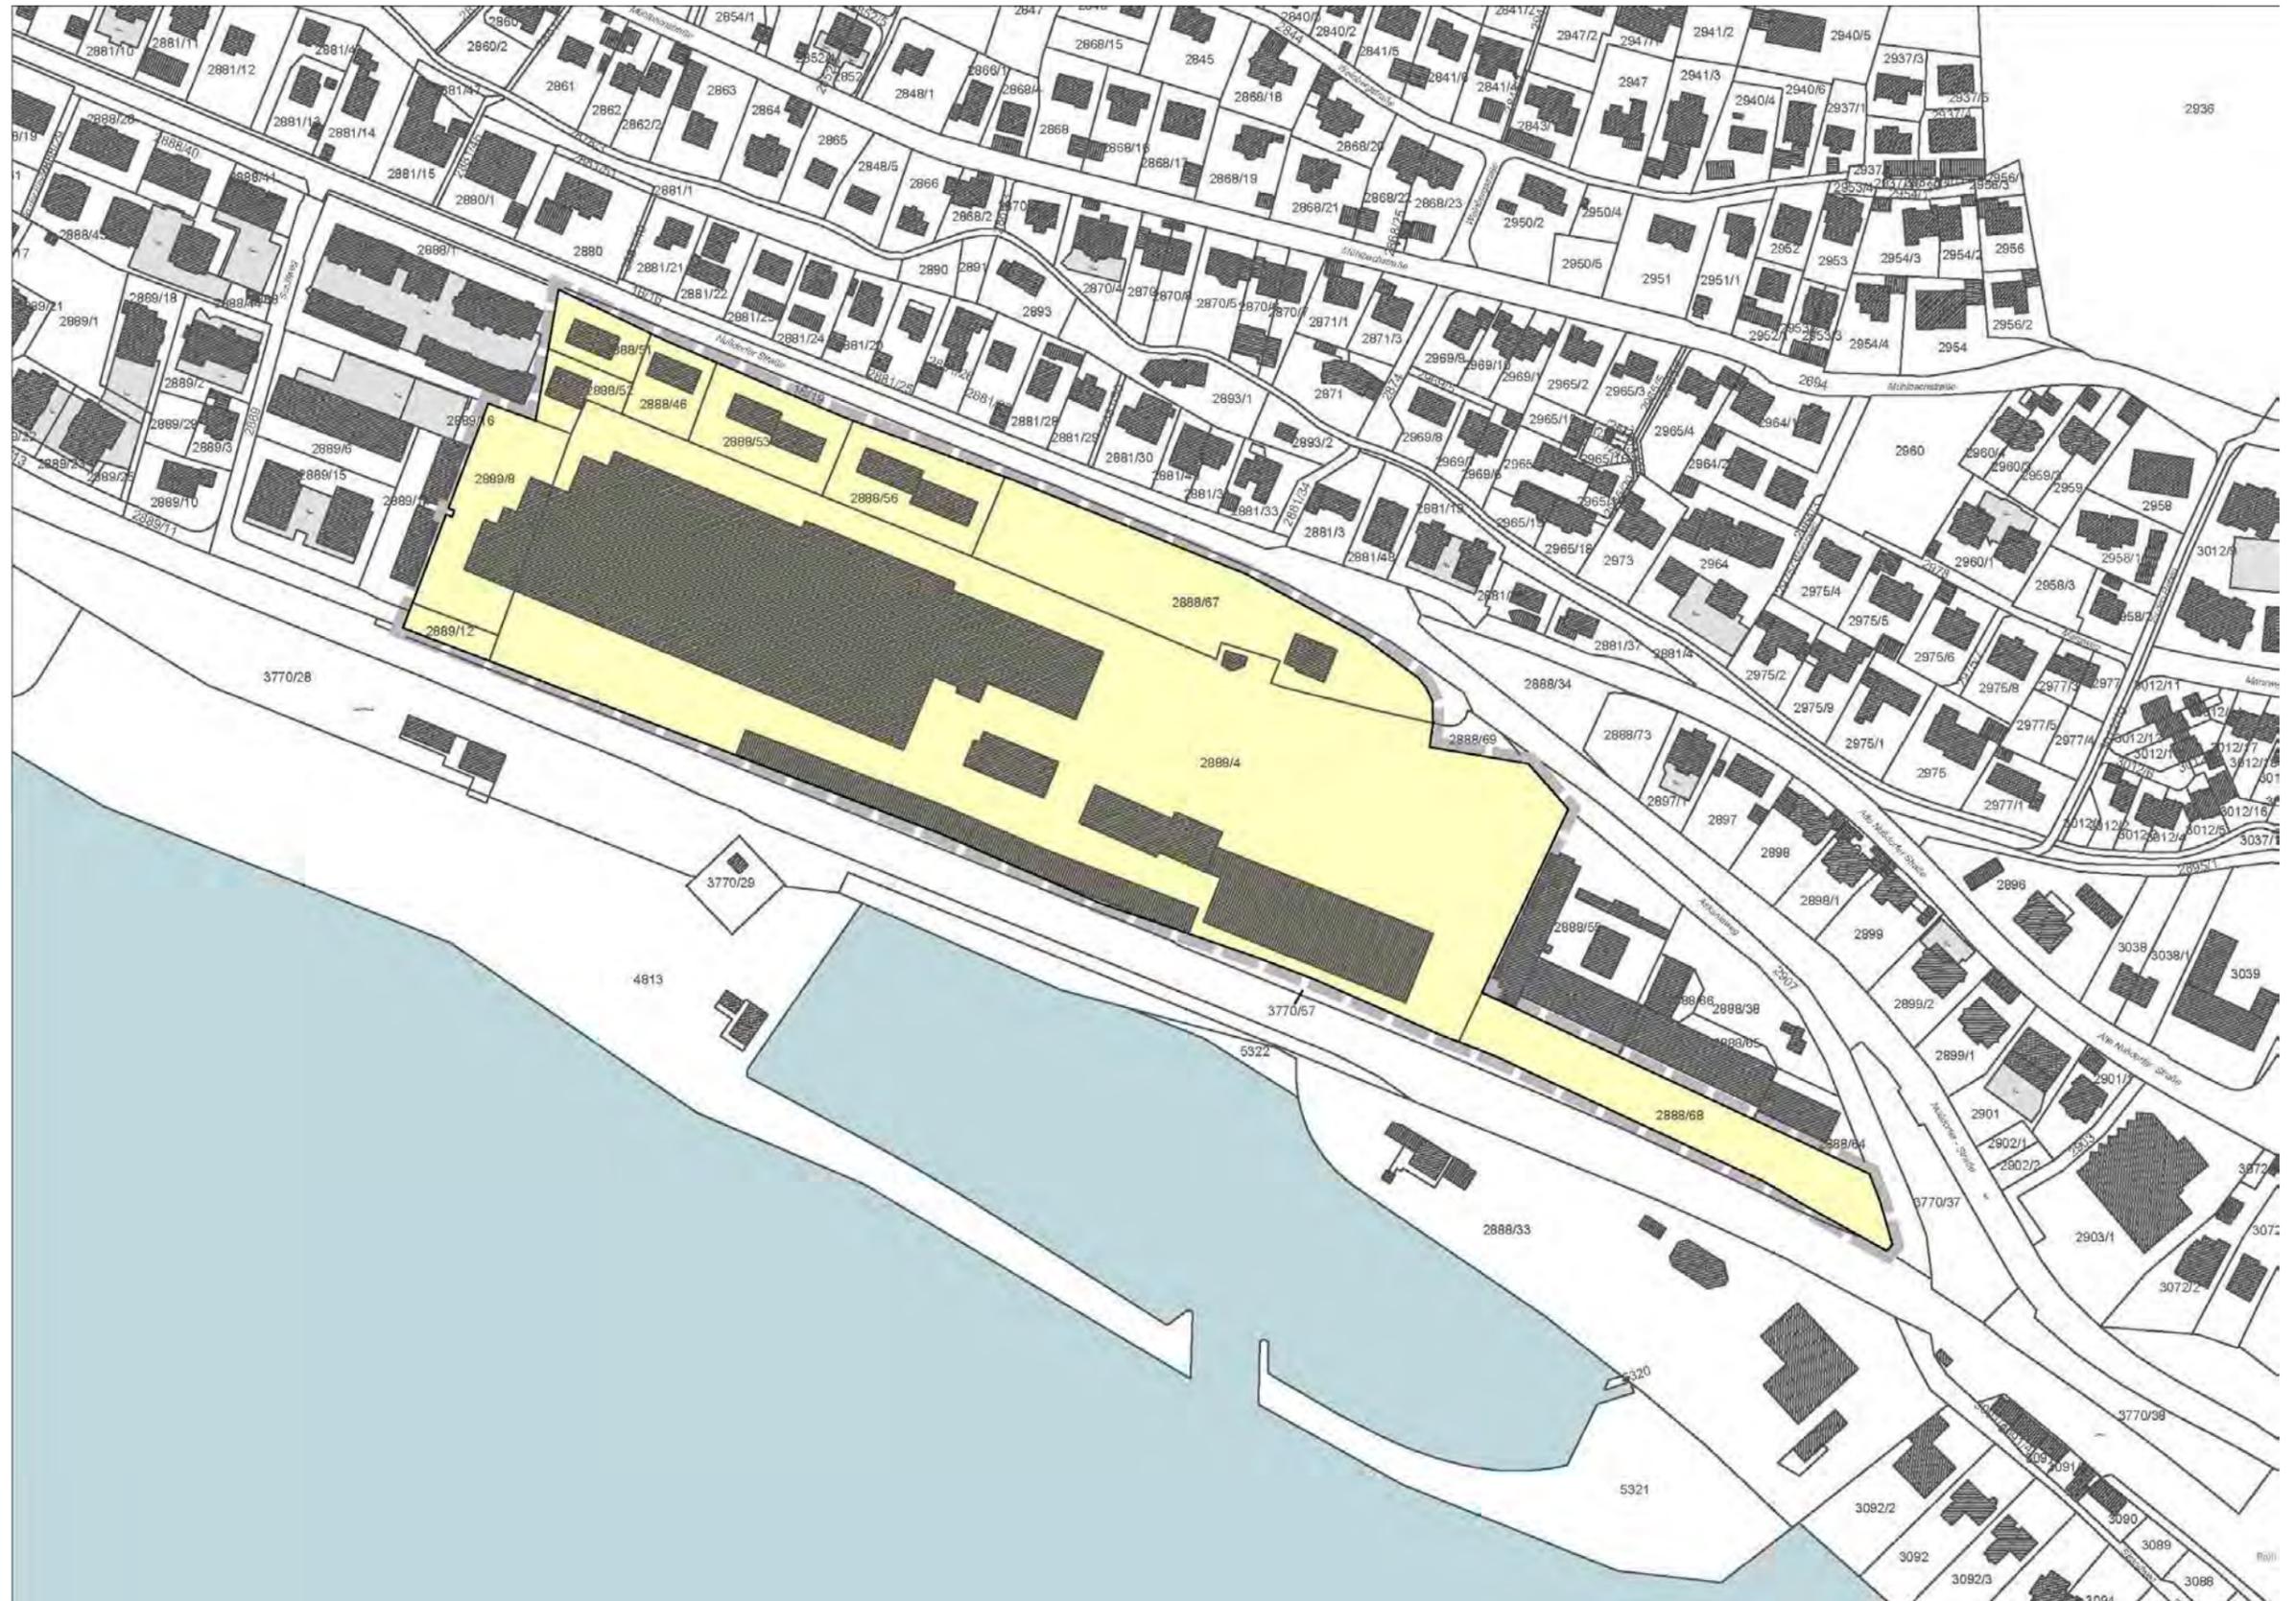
Lageplan mit Geltungsbereich (ohne Maßstab)
